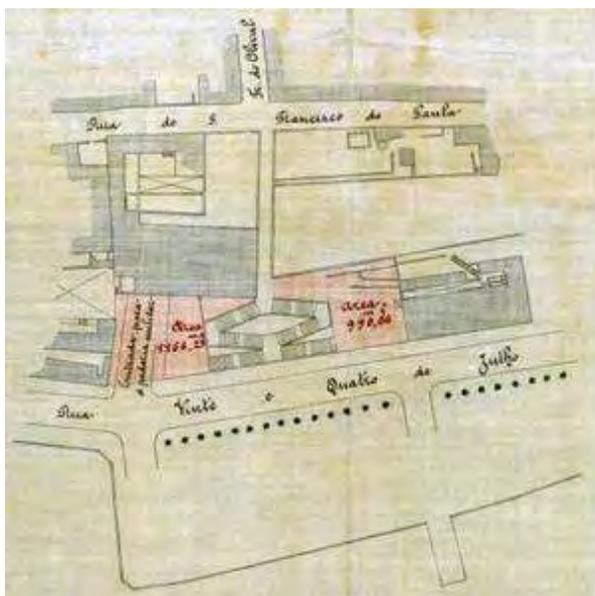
Planta da zona da Rocha de Conde de Óbidos com identificação de terrenos municipais a ladear a escadaria (1888) (Fonte: PT/AMLSB/CMLSB/UROB-E/23/0016)
